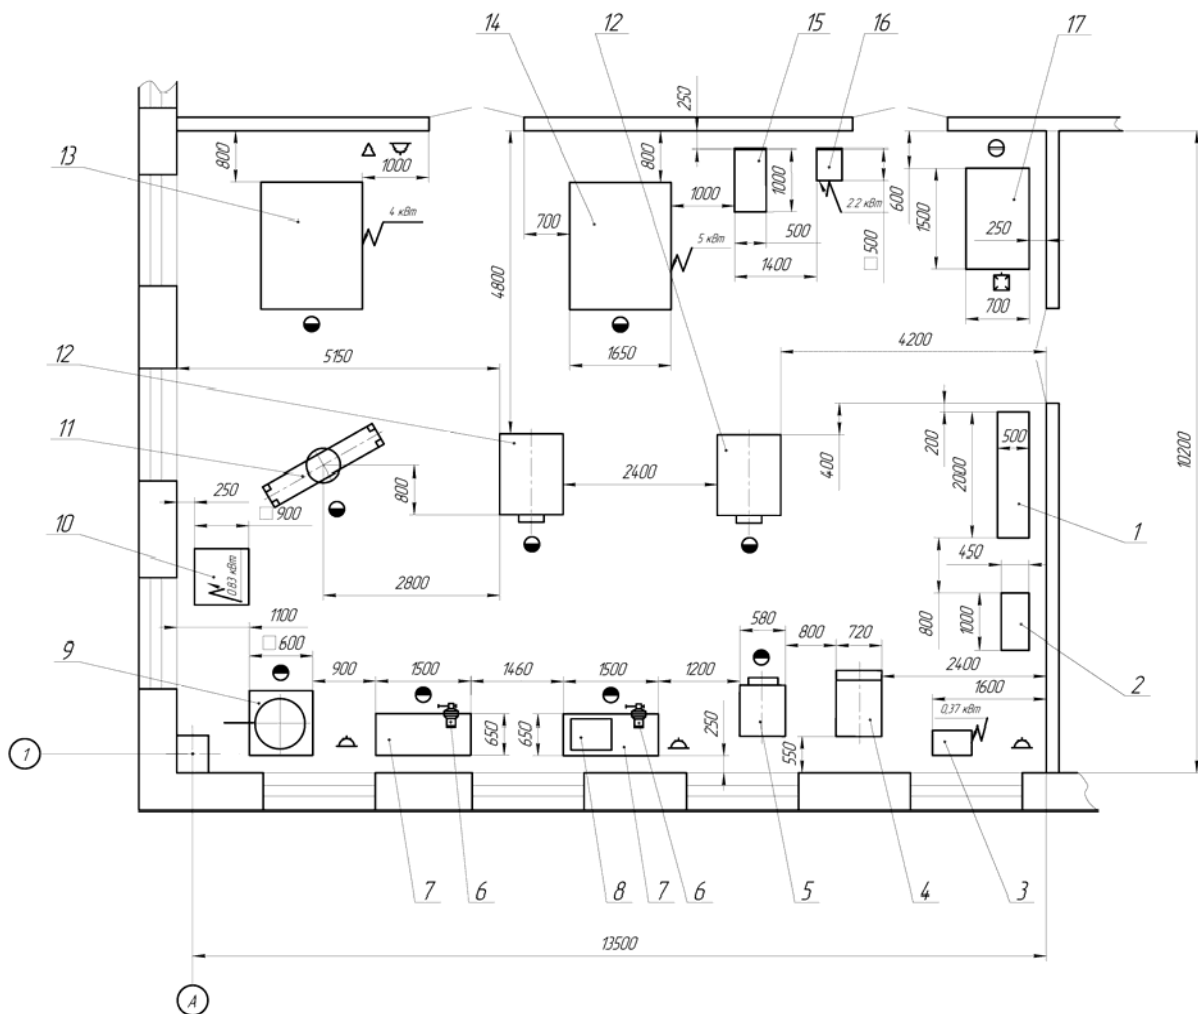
Участок ремонта агрегатов: 1 – стеллаж; 2 – шкаф для инструмента; 3 – установка для шлифовки клапанов, мод. Р-186; 4 – стенд для разборки и сборки коробок передач, мод. Р-201; 5 – стенд для разборки и сборки редукторов задних мостов, мод. Р-620; 6 – тиски слесарные, мод. Т-1; 7 – верстак слесарный, мод. ШП-17; 8 – стенд для разборки, сборки и регулировки сцеплений, мод. Р-207; 9 – пресс механический; 10 – установка для расточки тормозных барабанов, мод. Р-185; 11 – стенд для ремонта мостов автомобилей, мод. Р-421; 12 – стенд для разборки и сборки двигателей автомобилей, мод. Р-642; 13 – станок хонинговальный, мод. СС 100М
